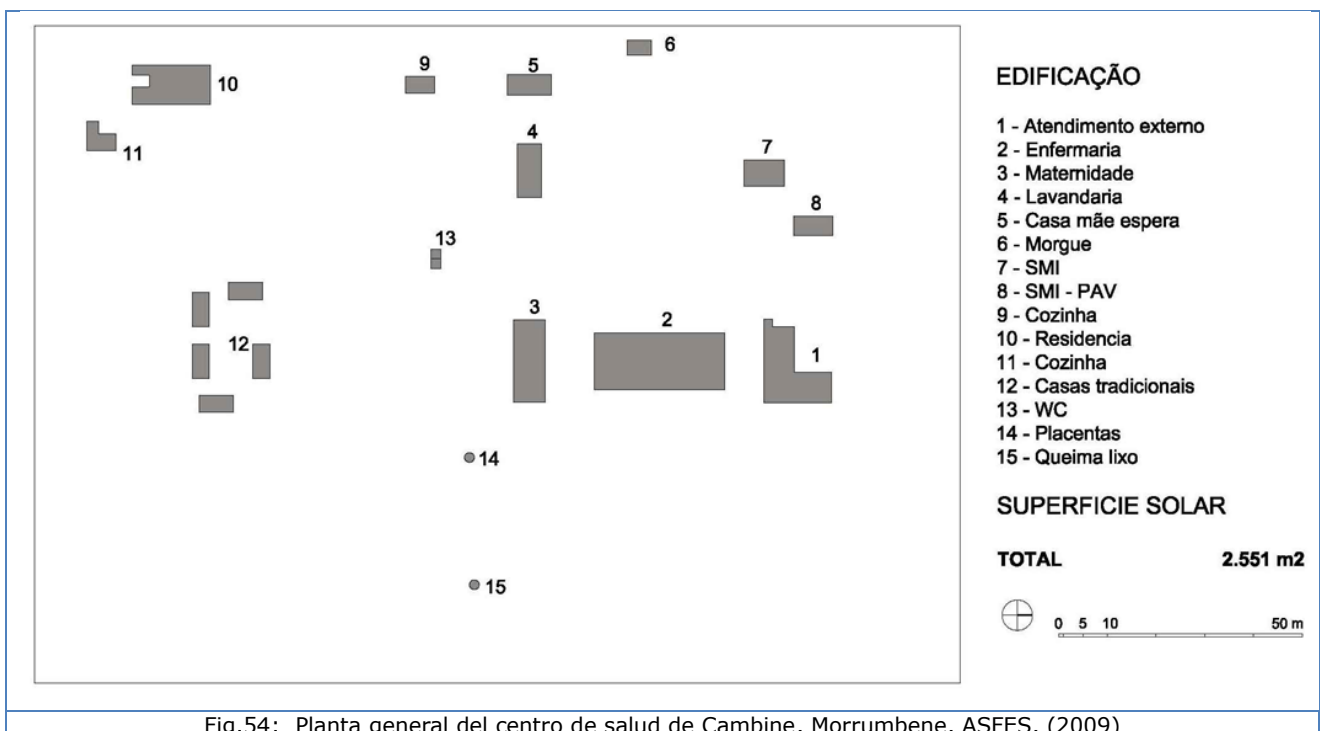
Planta general del centro de salud de Cambine, Morrumbene, ASFES, (2009)
